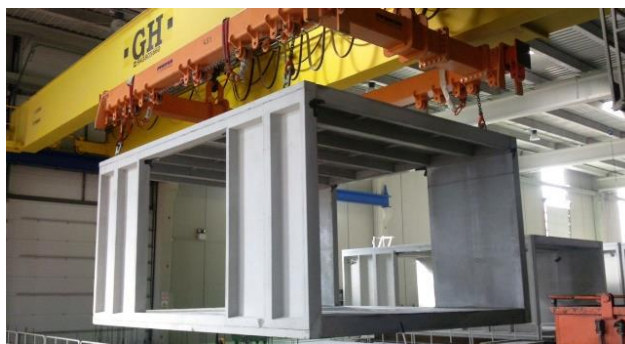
Paredes de betão pré-fabricadas (Keegan precast)
